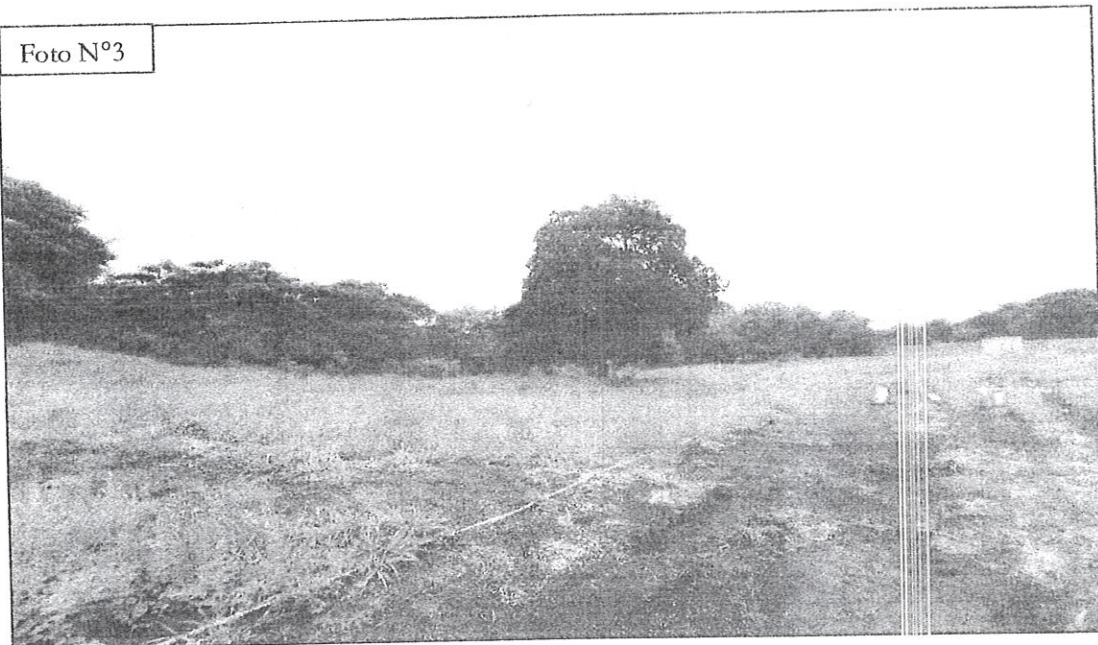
Vista general del terreno. Se observa la topografía y la vegetación.
